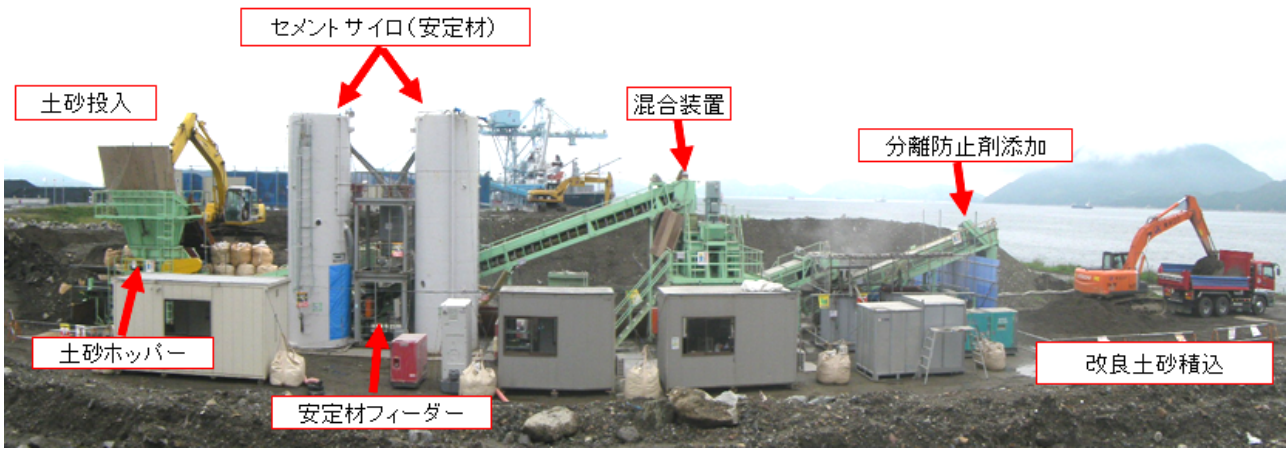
事前混合処理工法の施工・設備例（徳山下松港）
